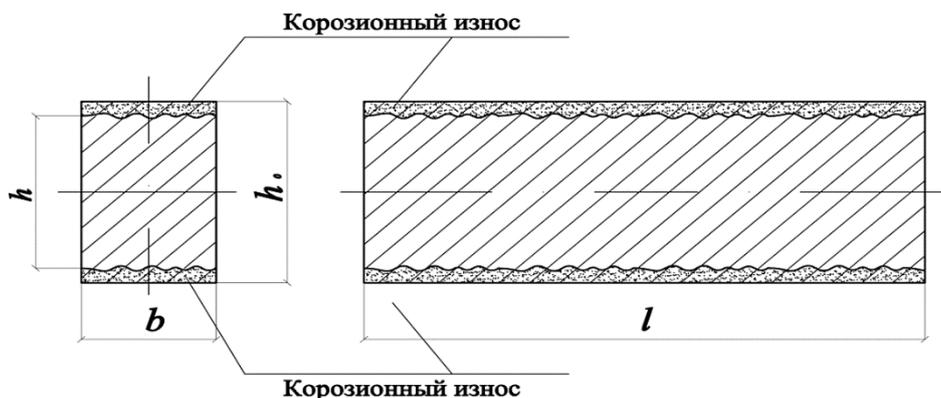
Коррозионный износ металлической балки прямоугольного сечения
